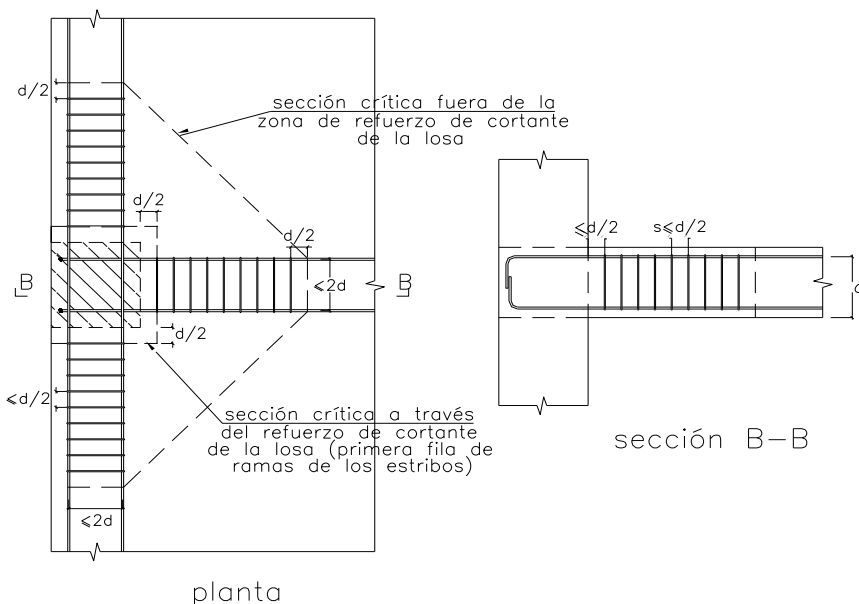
b Disposición de los estribos por cortante en columnas de borde.
